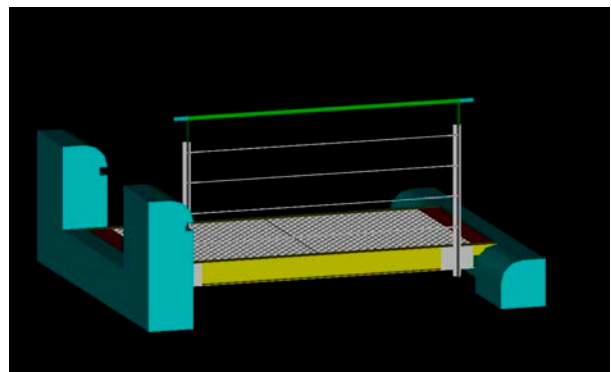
Schema der Brückenkonstruktion beim renaturierten Abschnitt 1
